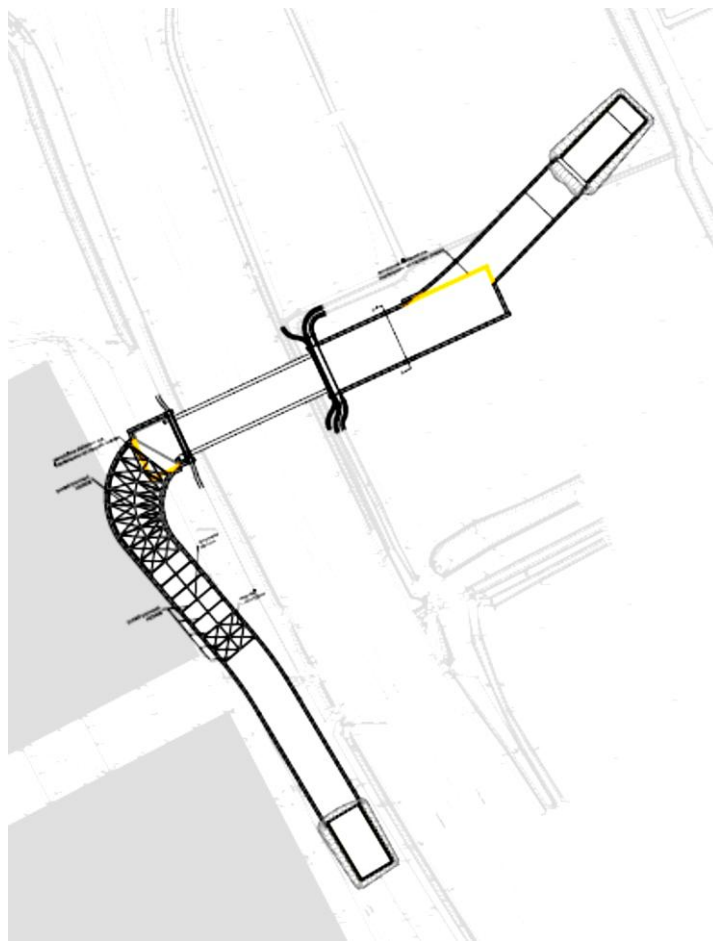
Planimetria del sottopasso di collegamento a seguito della costruzione di un edificio commerciale in zona urbanizzata
